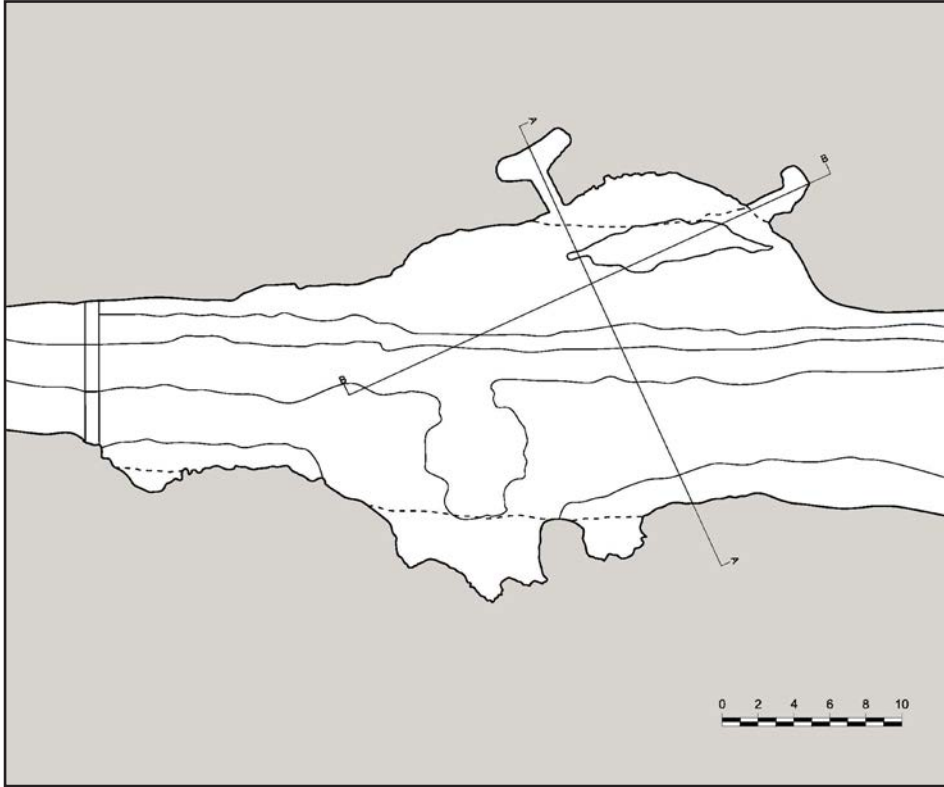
F. Stilo, Caforchì, pianta generale, 2020.
